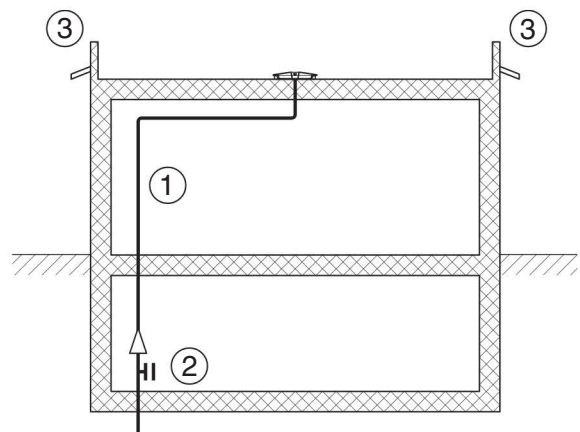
Übersicht Flachdach mit Geberit Pluvia Dachwassereinlauf
